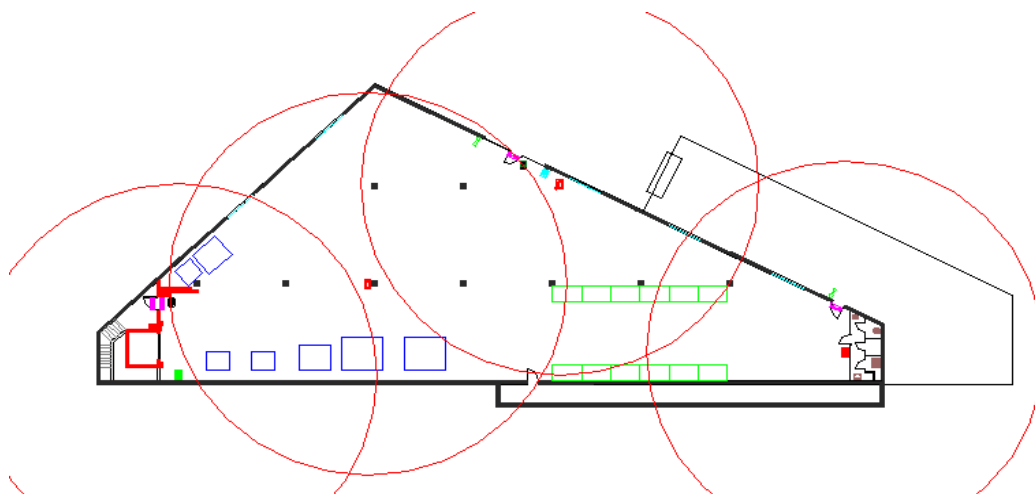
Superficie cubierta por los extintores en la planta baja del edificio Oficinas
